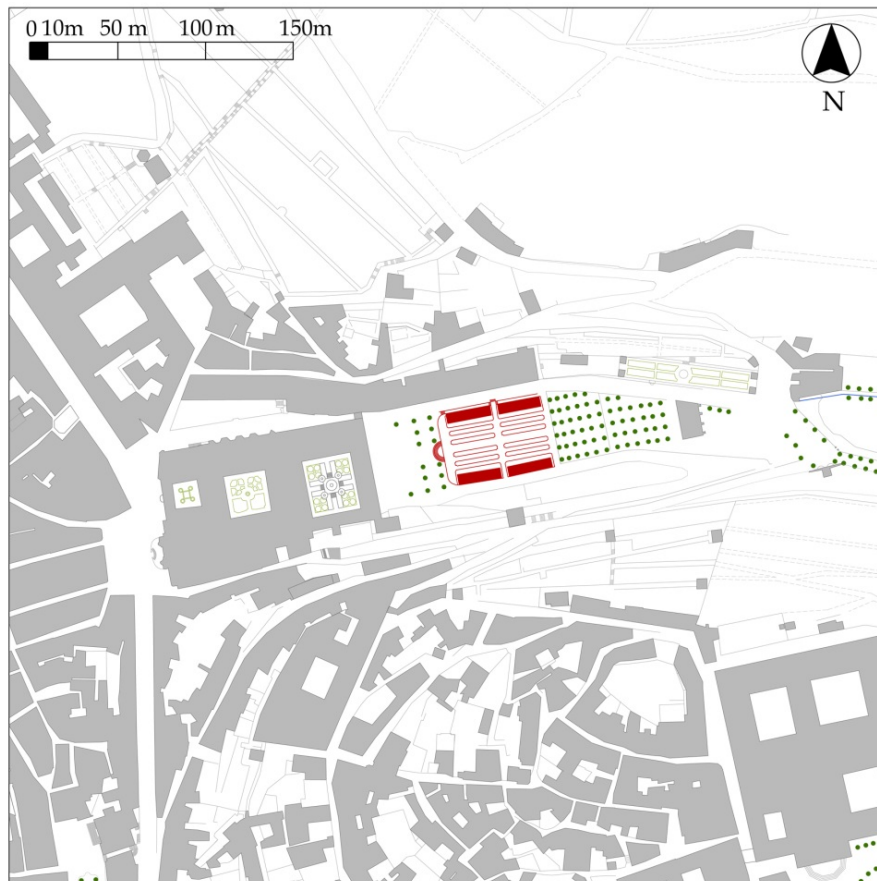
Planta de reconstituição da implantação do Mercado D. Pedro V, inaugurado no dia 17 de Novembro de 1867.
